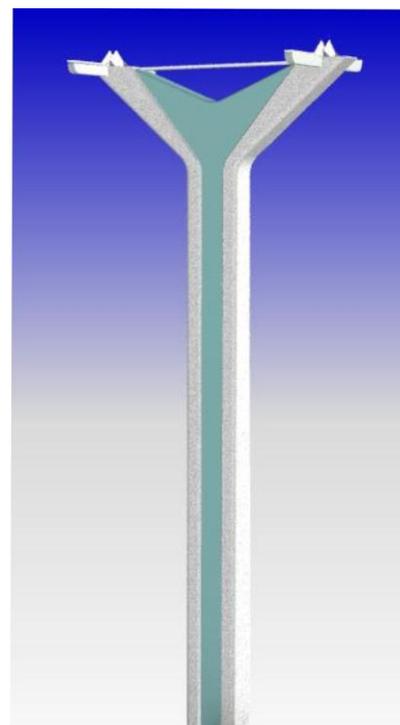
Промежуточная железобетонная поддерживающая опора одного пути бирельсового СТЮ с основанием прямоугольного сечения
